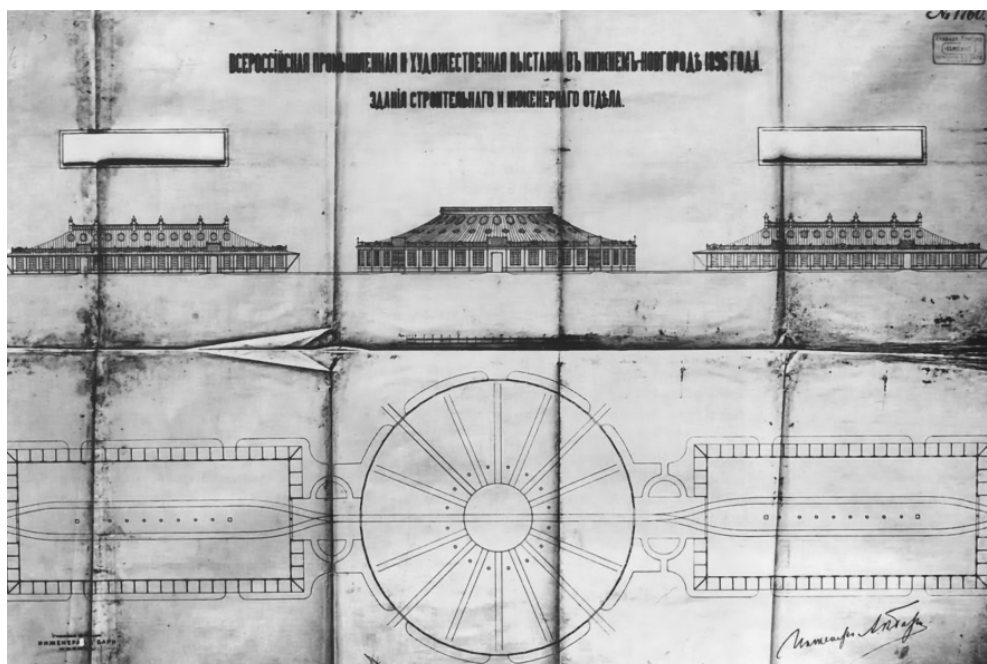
Всероссийская промышленная и художественная выставка в Нижнем Новгороде, 1896 г. Ротонда и прямоугольные здания строительного и инженерного отдела с деревянными покрытиями. Чертеж с фасадами и планами (69,6 x 103 см)
